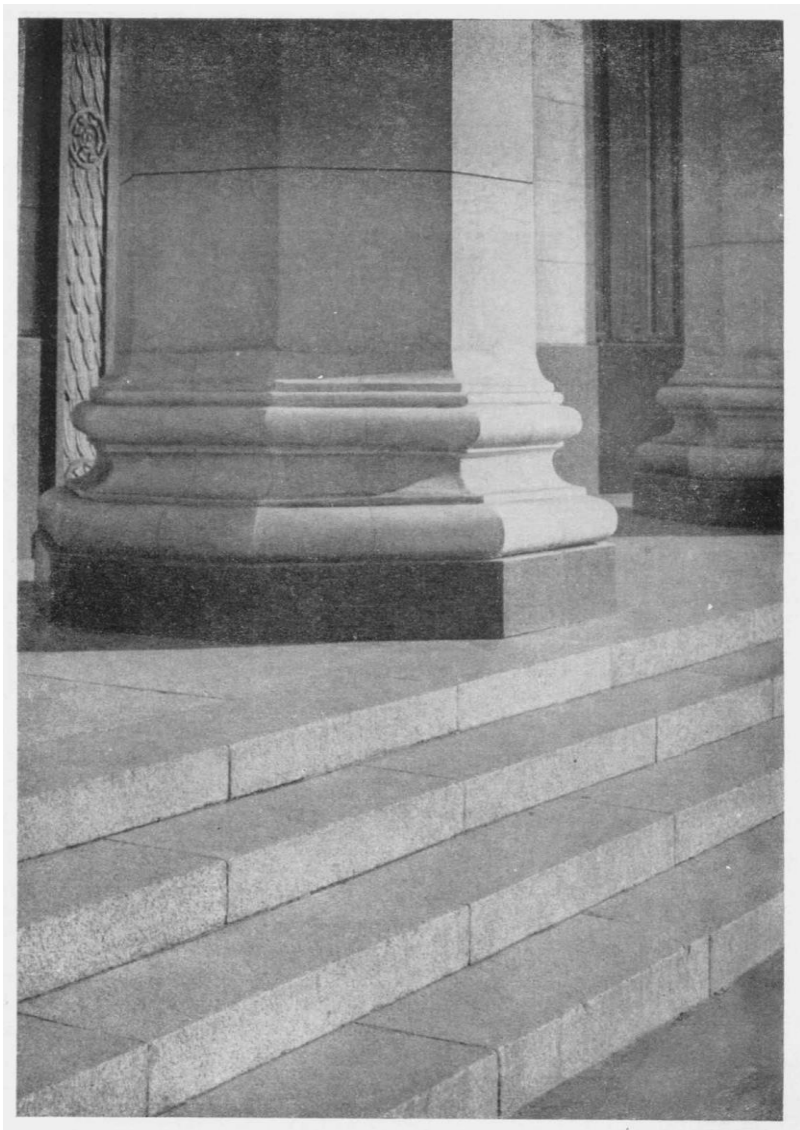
Лестница с гранитными ступенями прямоугольного сечения (Базы восьмигранных штукатурных колонн выполнены из шлифованного
